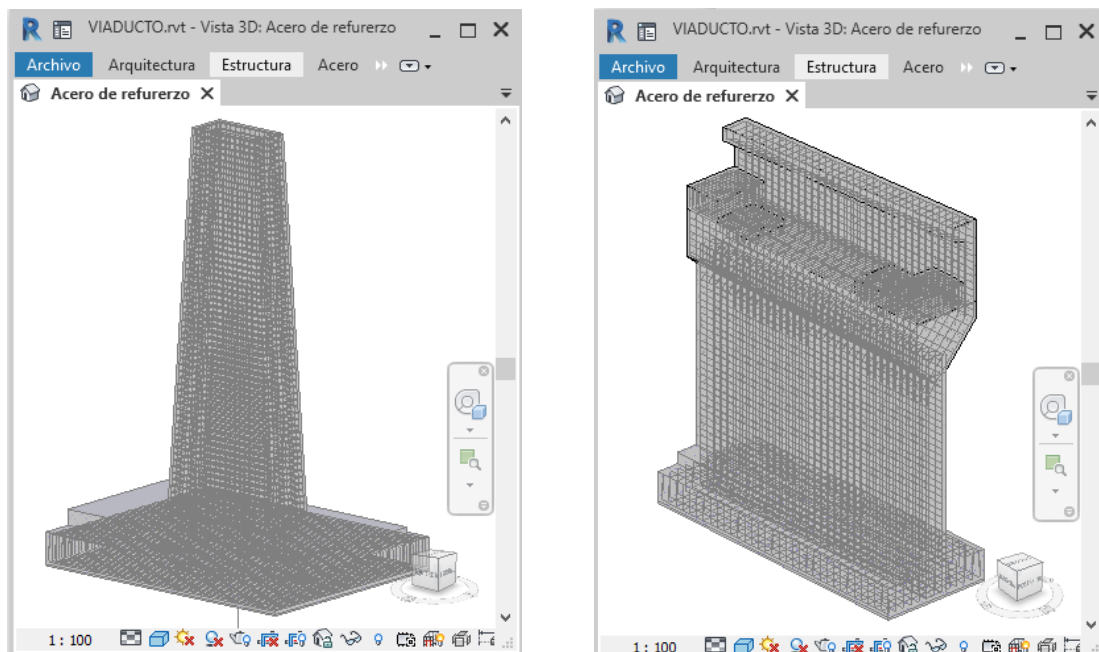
Modelado de barras de acero en Columnas y Muros. Fuente: Elaboración propia
